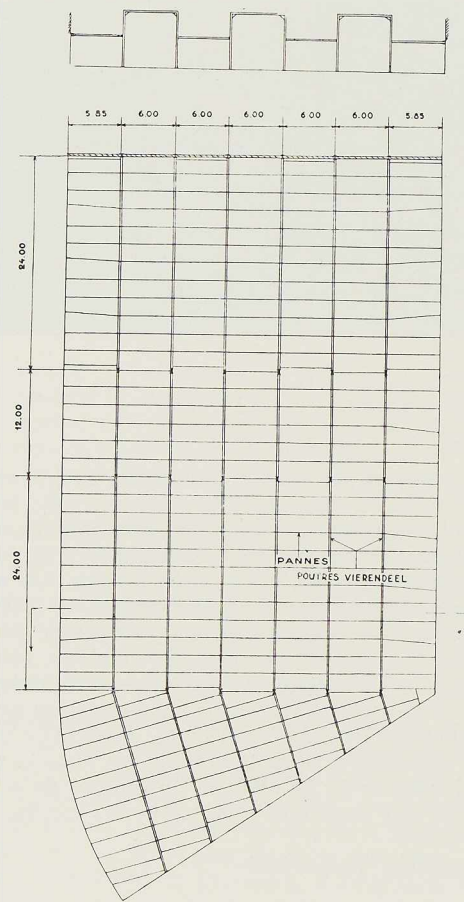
Vue en plan du poutrellage de la toiture des ateliers de cuisson.
